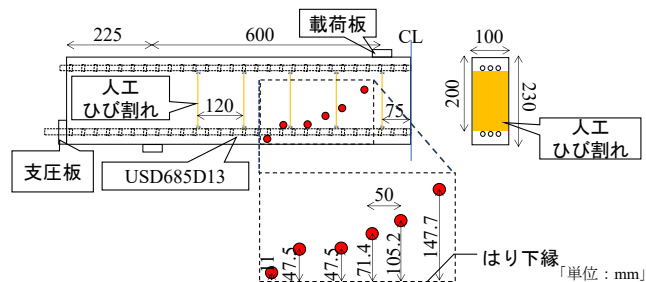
に試験体の形状および寸法を、表一 1 に試験体の諸元をそれぞれ示す。せん断破壊を確実に先行させるため、引張主鉄筋には高強度鉄筋を使用した。厚さが 0.13 mm のアルミテープを 2 枚張り合わせた状態で型枠に固定し、打設を行うことで、はりの側面方向に貫通する平滑な人工ひび割れを導入した。人工ひび割れは圧縮主鉄筋と引張主鉄筋の間にはり高方向の幅が 150 mm になるよう導入した。直径が 22 mm の塩化ビニル製パイプを型枠に設置した状態で打設を行い、コンクリートが硬化した後にパイプを引き抜くことで穿孔を導入した。載荷実験は 4 点曲げ載荷の条件で行った。
